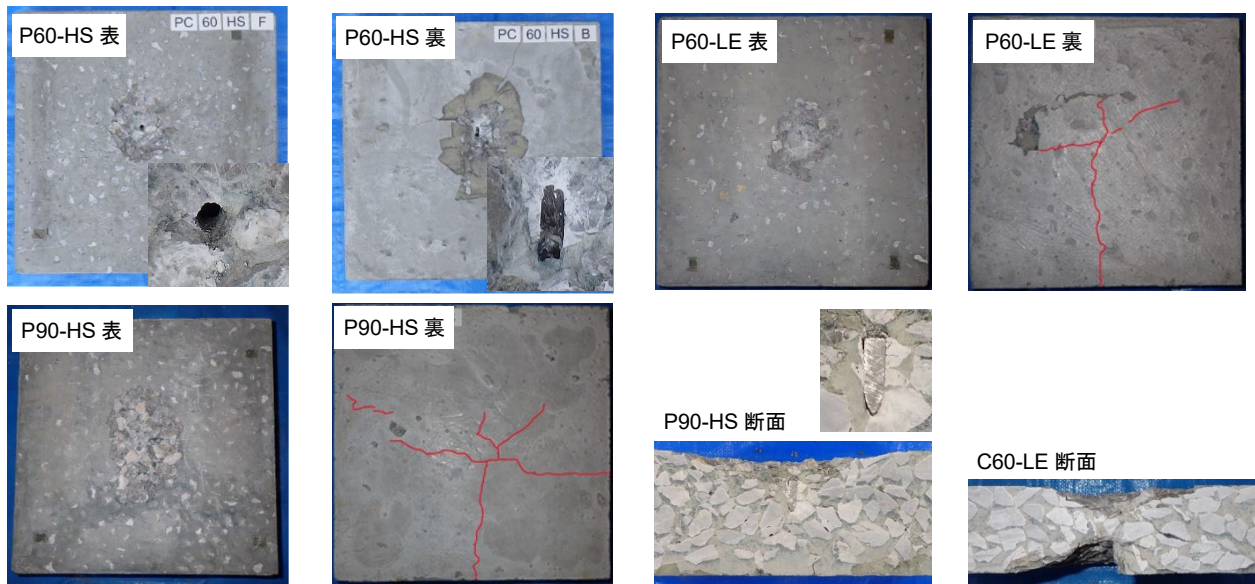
実験後の P 試験体の外観（裏面の写真では赤でひび割れを強調）
